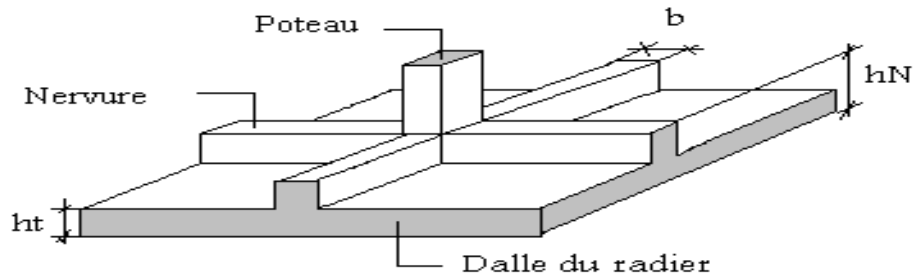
Disposition des nervures par rapport au radier et aux poteaux.
